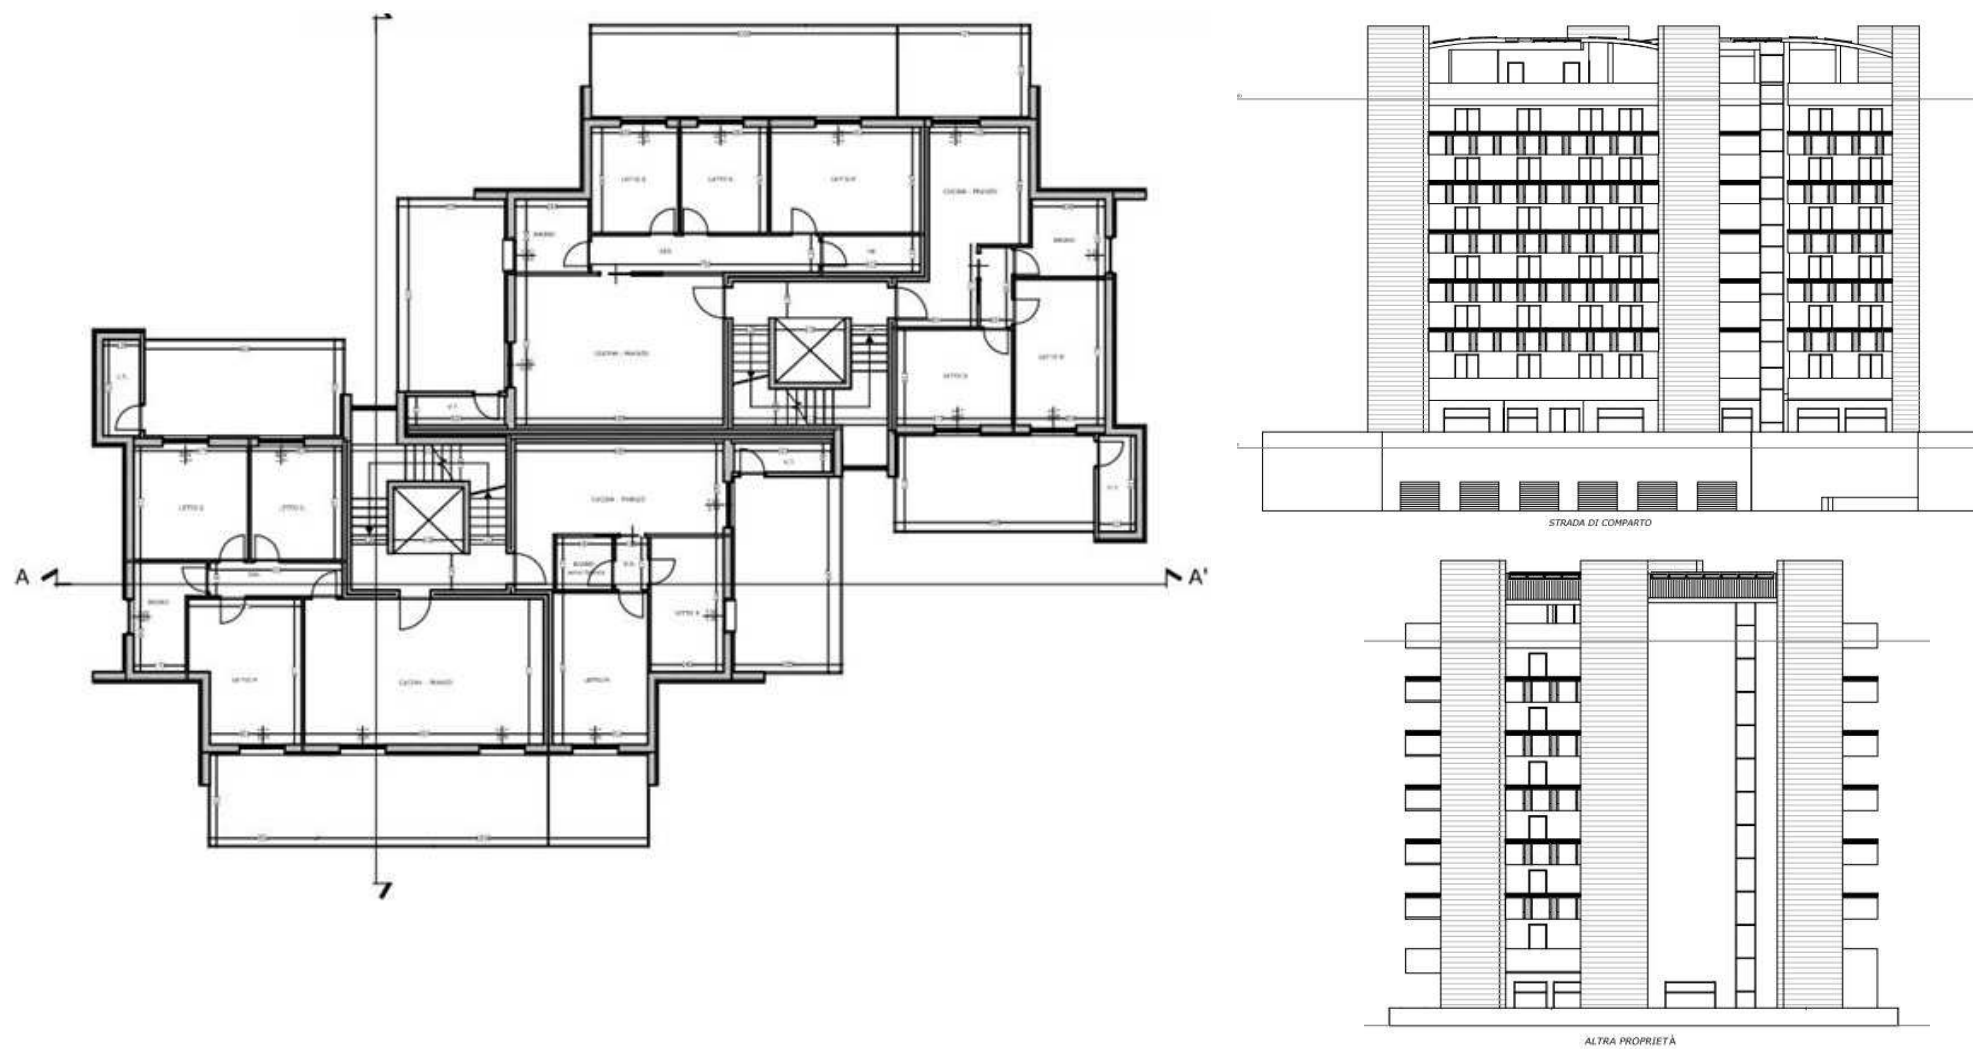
Blocco A2 – Prospetto anteriore, prospetto laterale sinistro e pianta piano tipo
